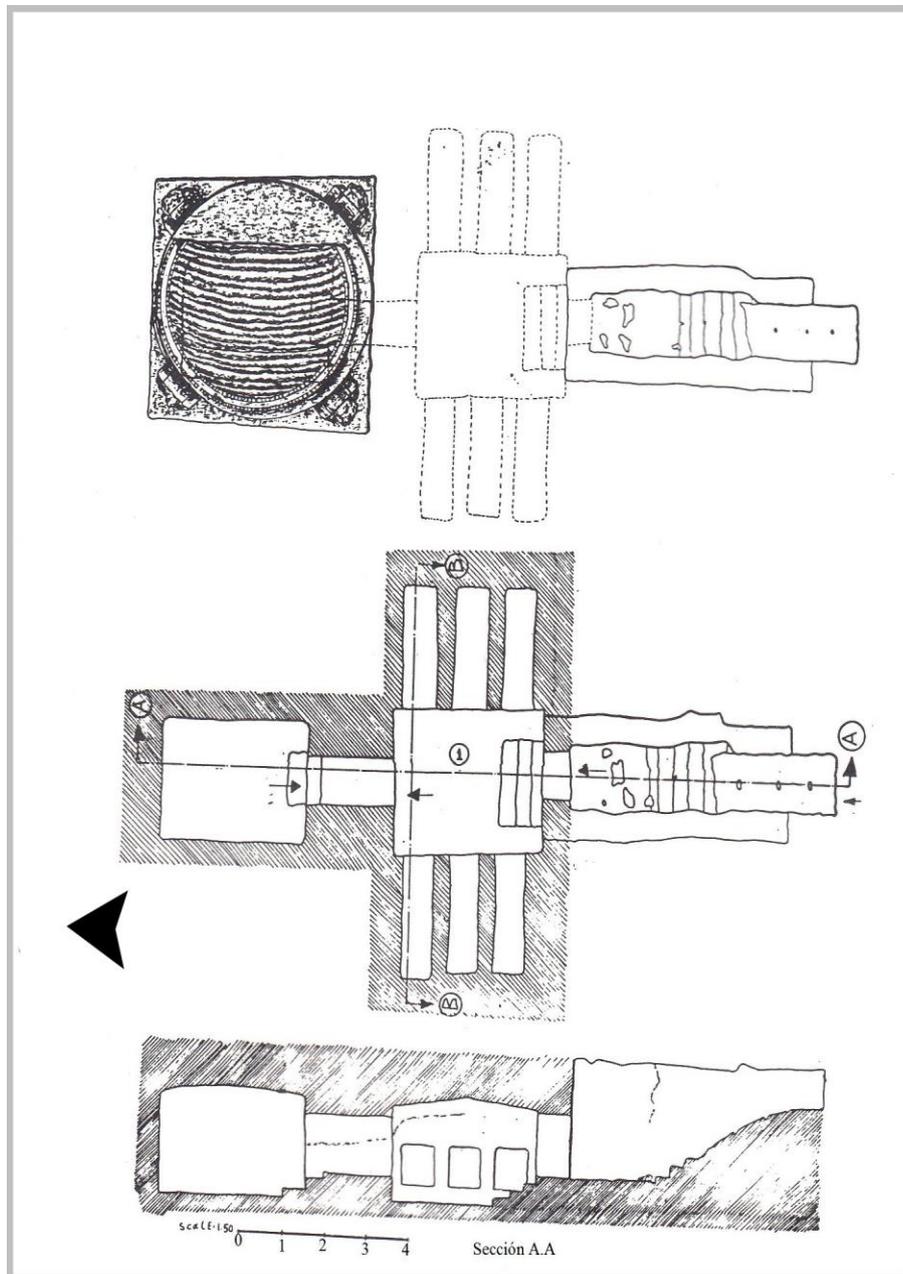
Planta, sección longitudinal y detalle de la tumba.
